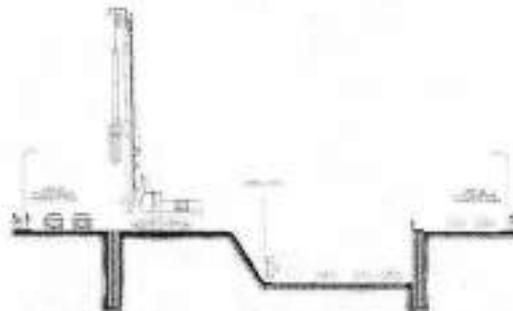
Esquema de procedimiento constructivo de by-pass mediante muros de pilotes en las zonas de puentes
